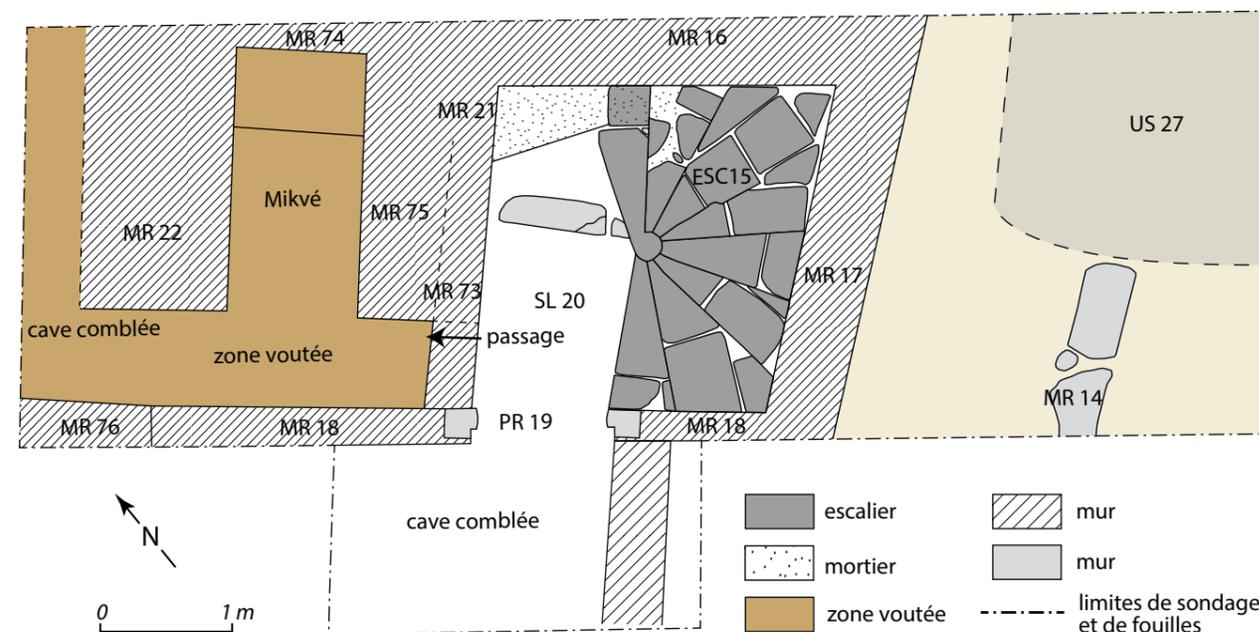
PERNES-LES-FONTAINES, Place de la Juiverie. Plan général de la zone de fouille (relevé : G. Baro et D. Lavergne, DAO : G. Baro).
